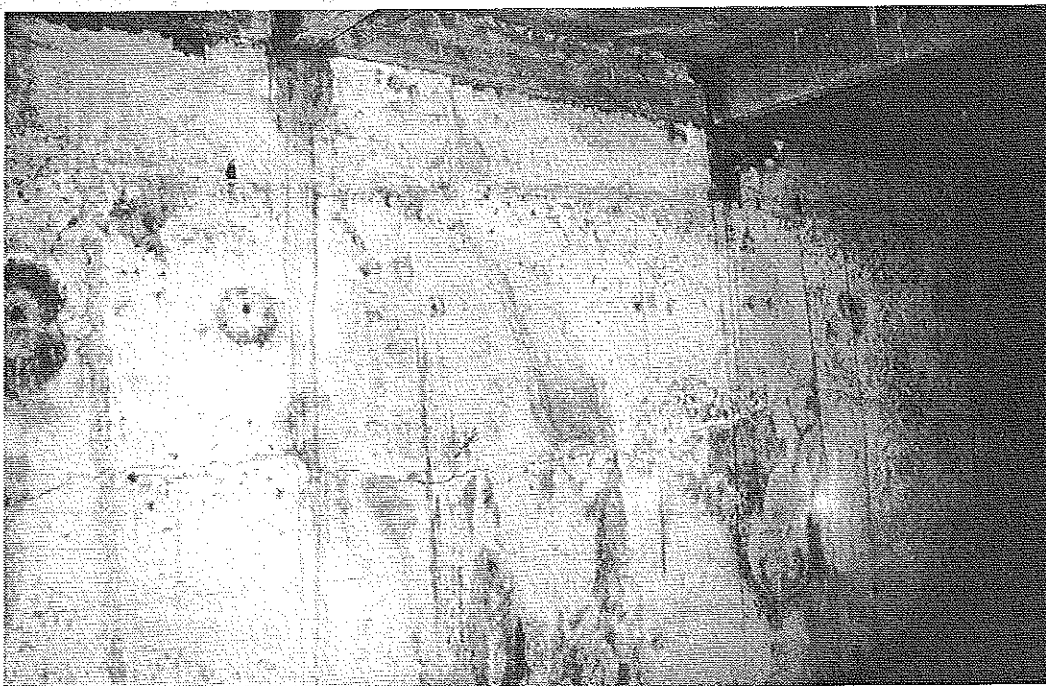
Fissure longitudinale d'un voile porteur. © J. Putatti
